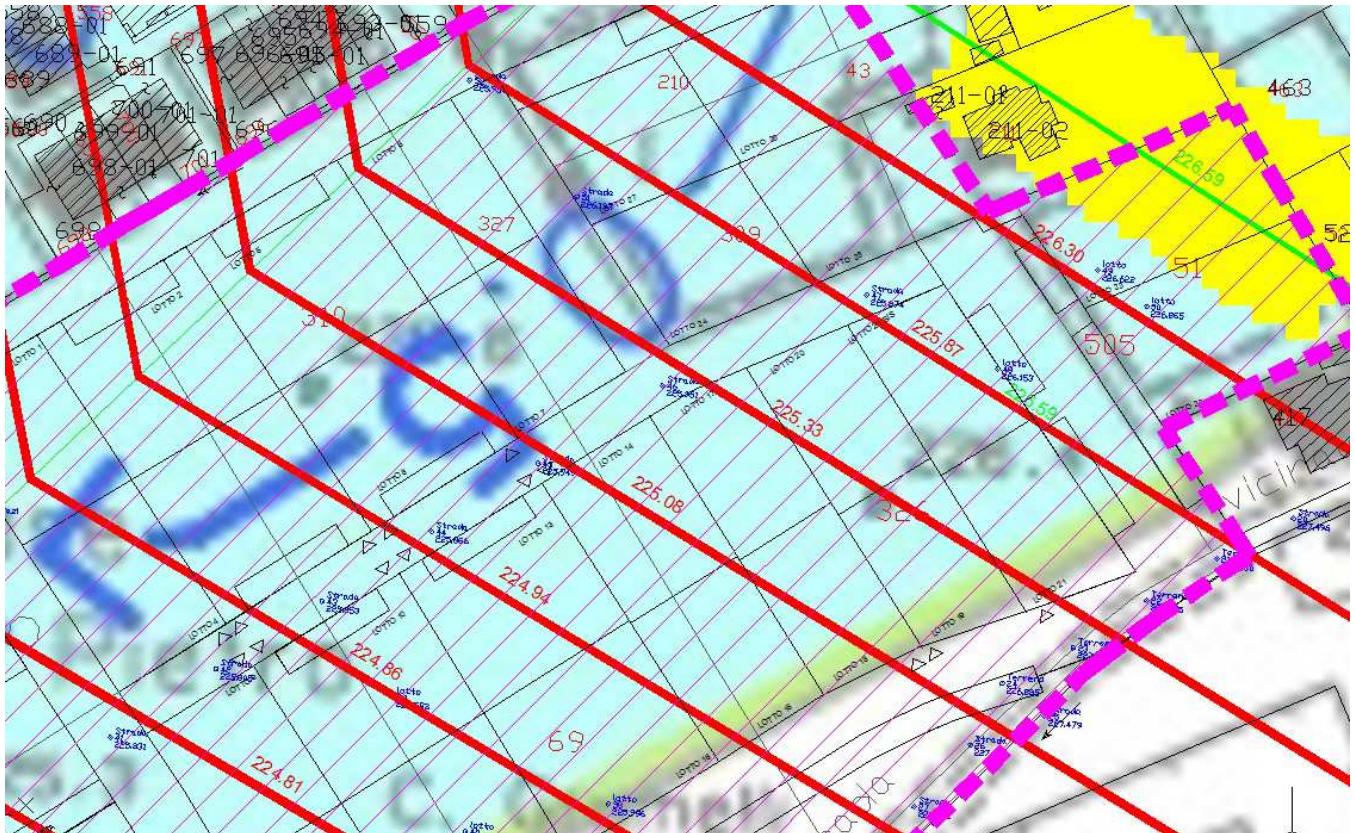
Planimetria generale della lottizzazione sovrapposta alla Carta delle Fasce fluviali e dell'indicazione delle sezioni di deflusso extra-alveo – Zoom 1 –
